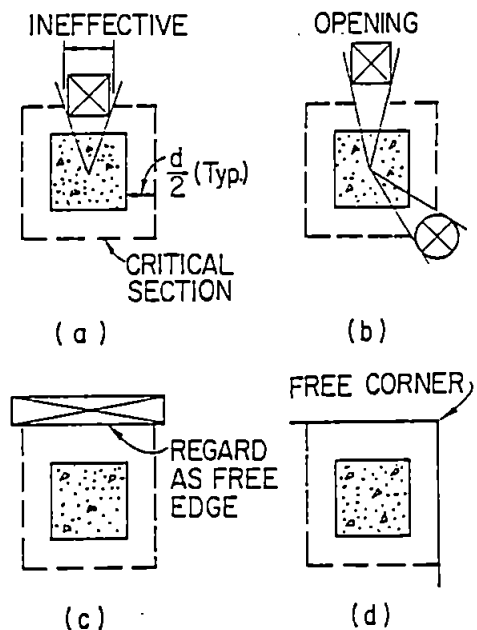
Efecto de aberturas en la losa y extremos libres (las líneas discontinuas muestran el perímetro efectivo).
